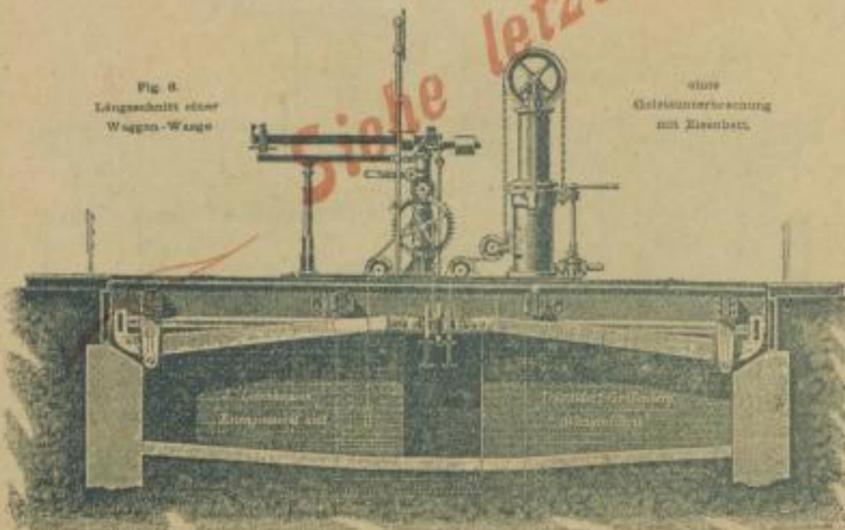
Längsschnitt einer Waagen-Waage ohne Geleisunterbrechung mit Eisenbett.
